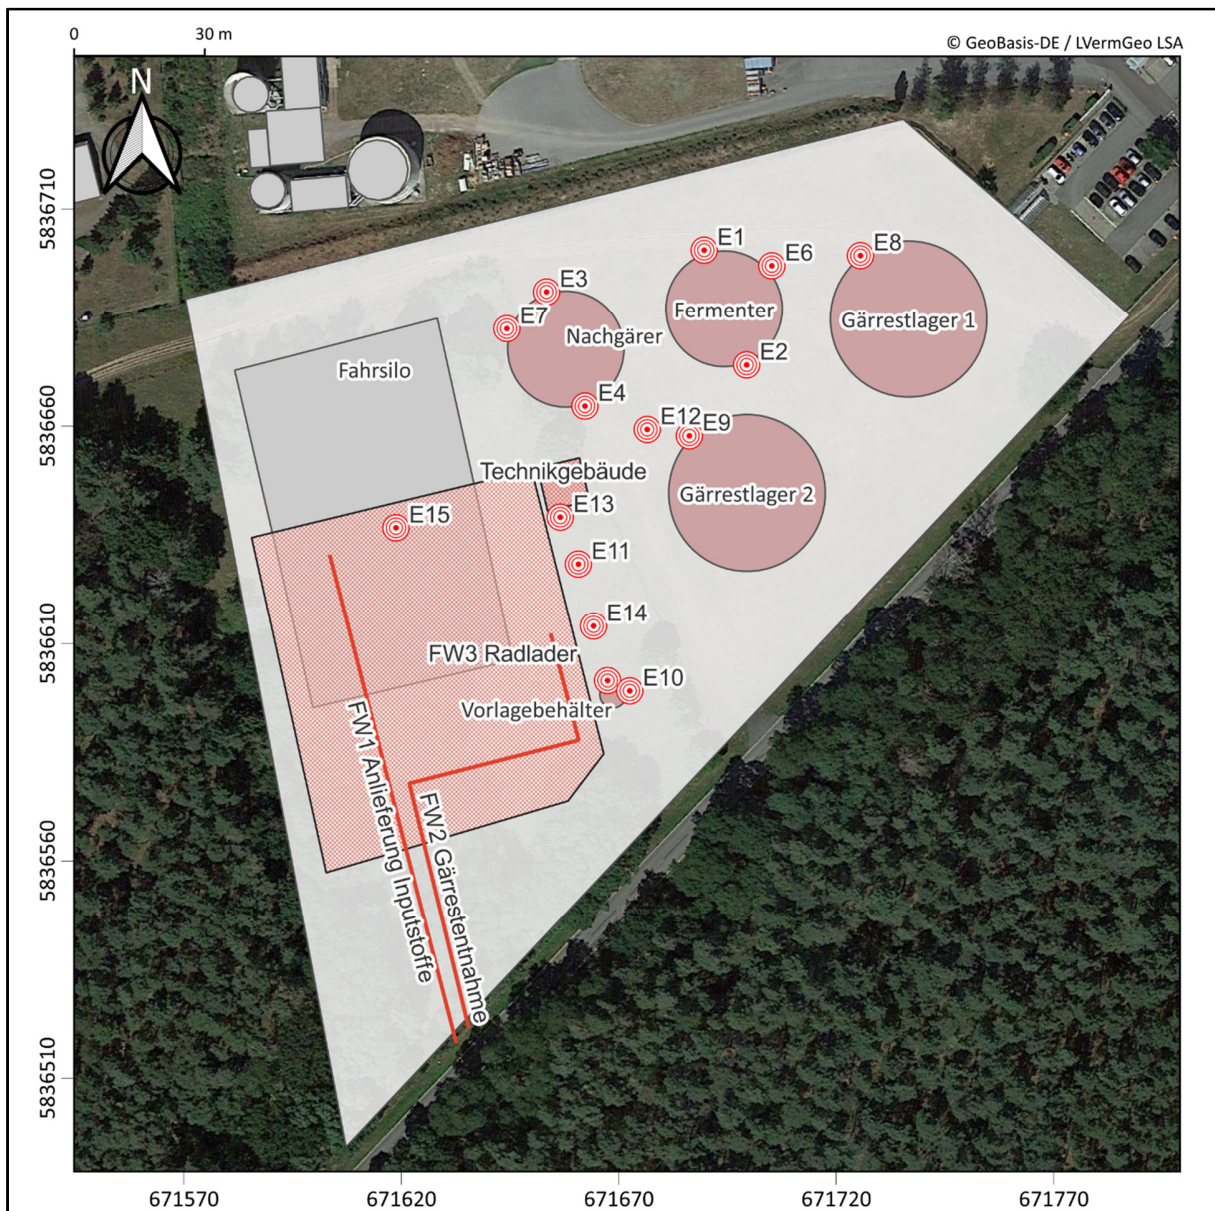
Lageplan Schallquellen der geplanten Biogasanlage (ETRS89 UTM32N)
